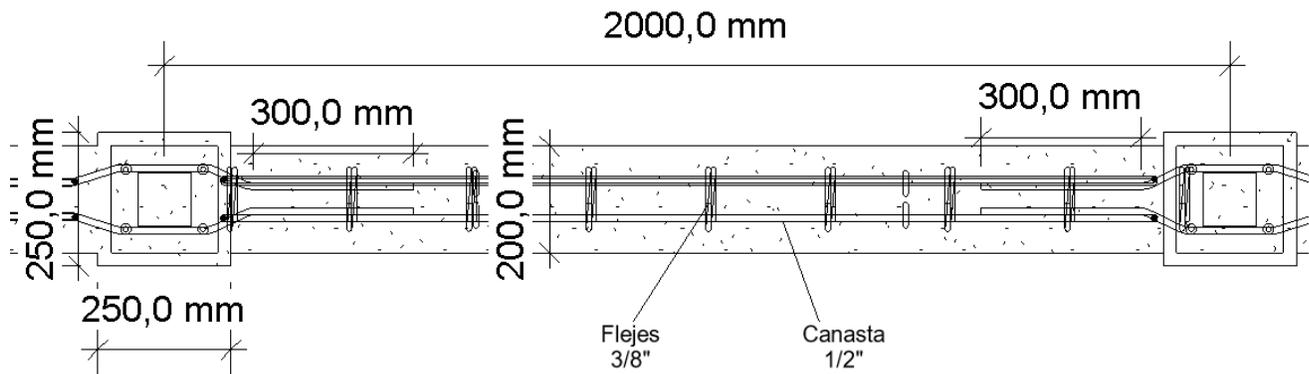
Esquema de ubicación de refuerzo en vista transversal
